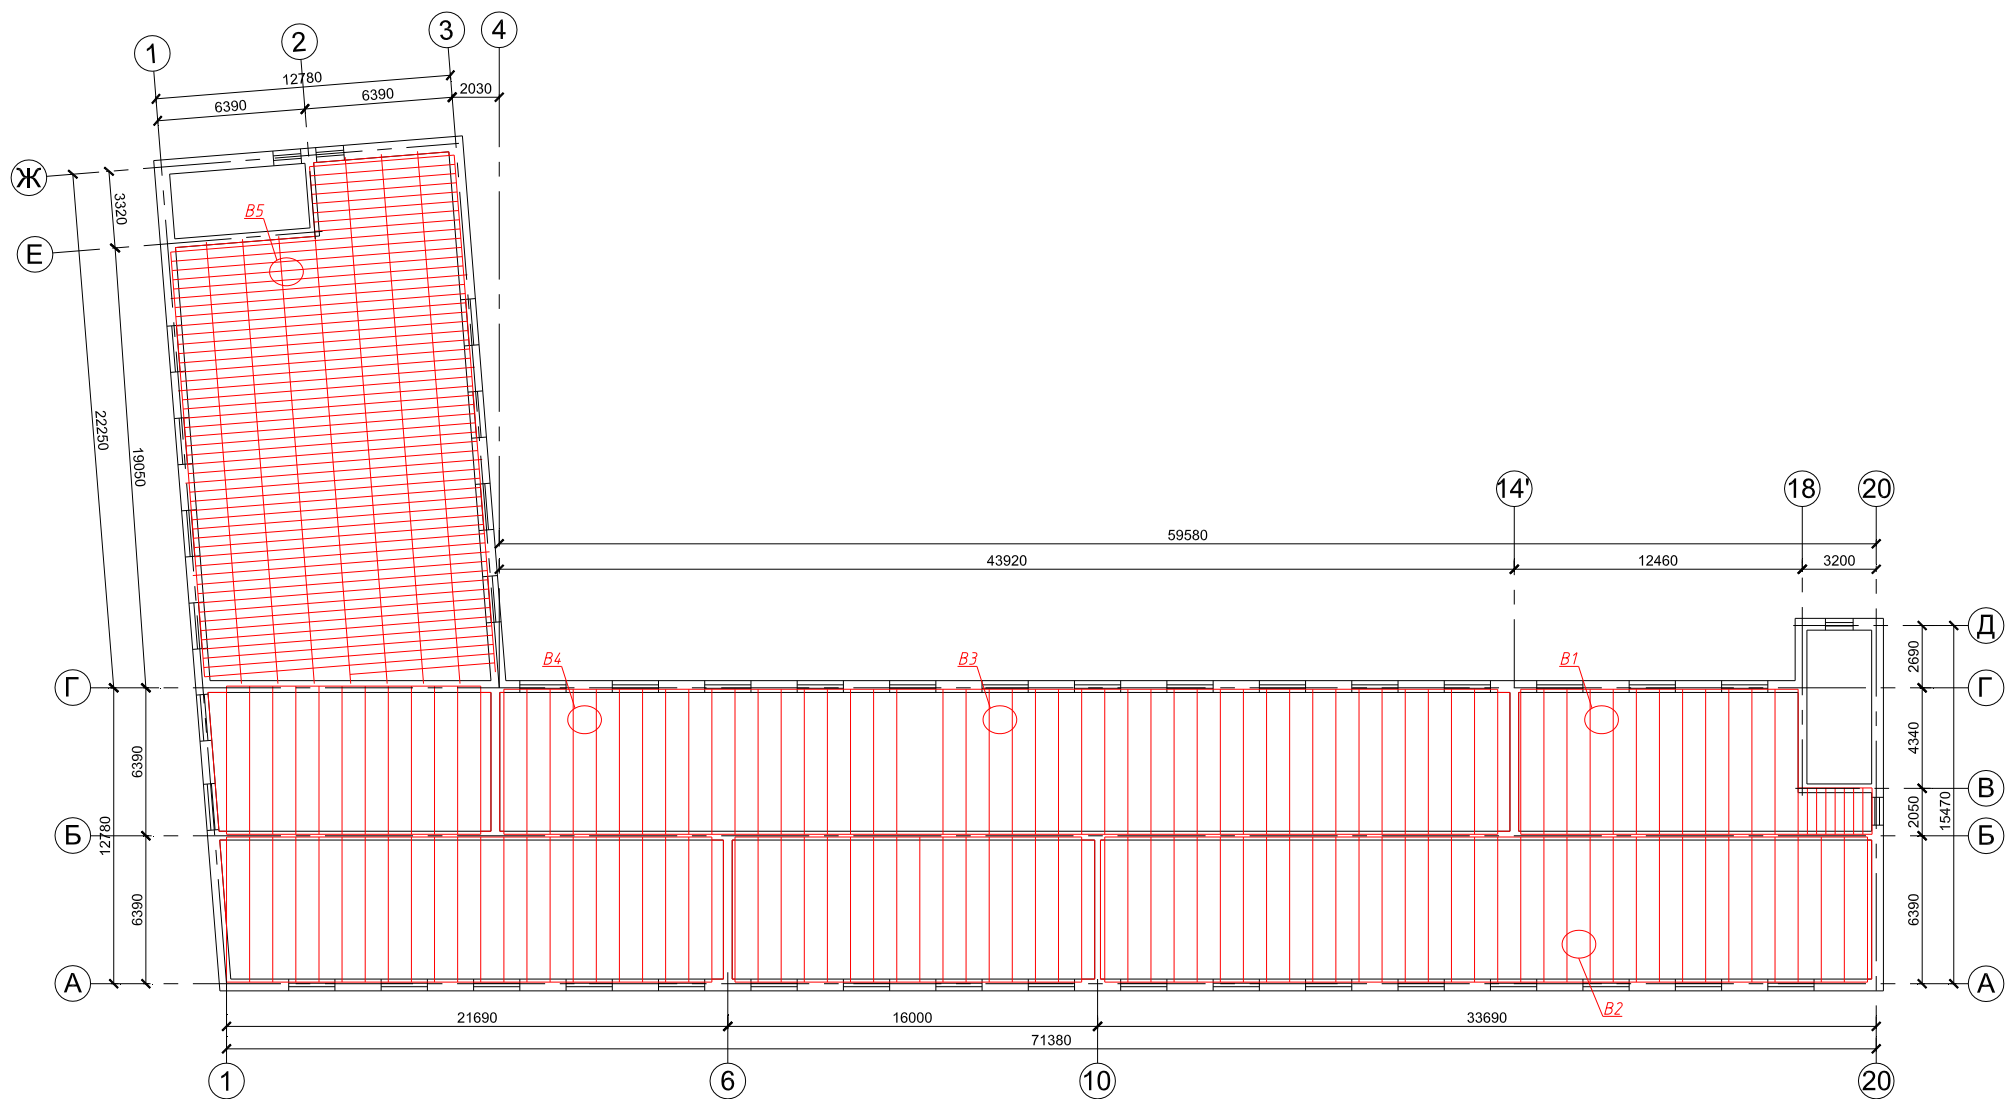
Схема расположения мест вскрытий конструкций перекрытия над четвертым этажом здания.
